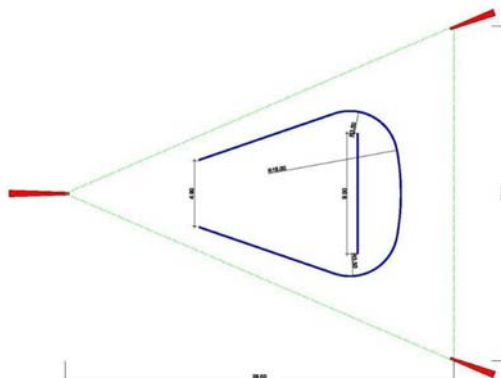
Planta da Igreja Nossa Senhora de Fátima. Desenho do Autor – adaptado de planta original (IPHAN).
